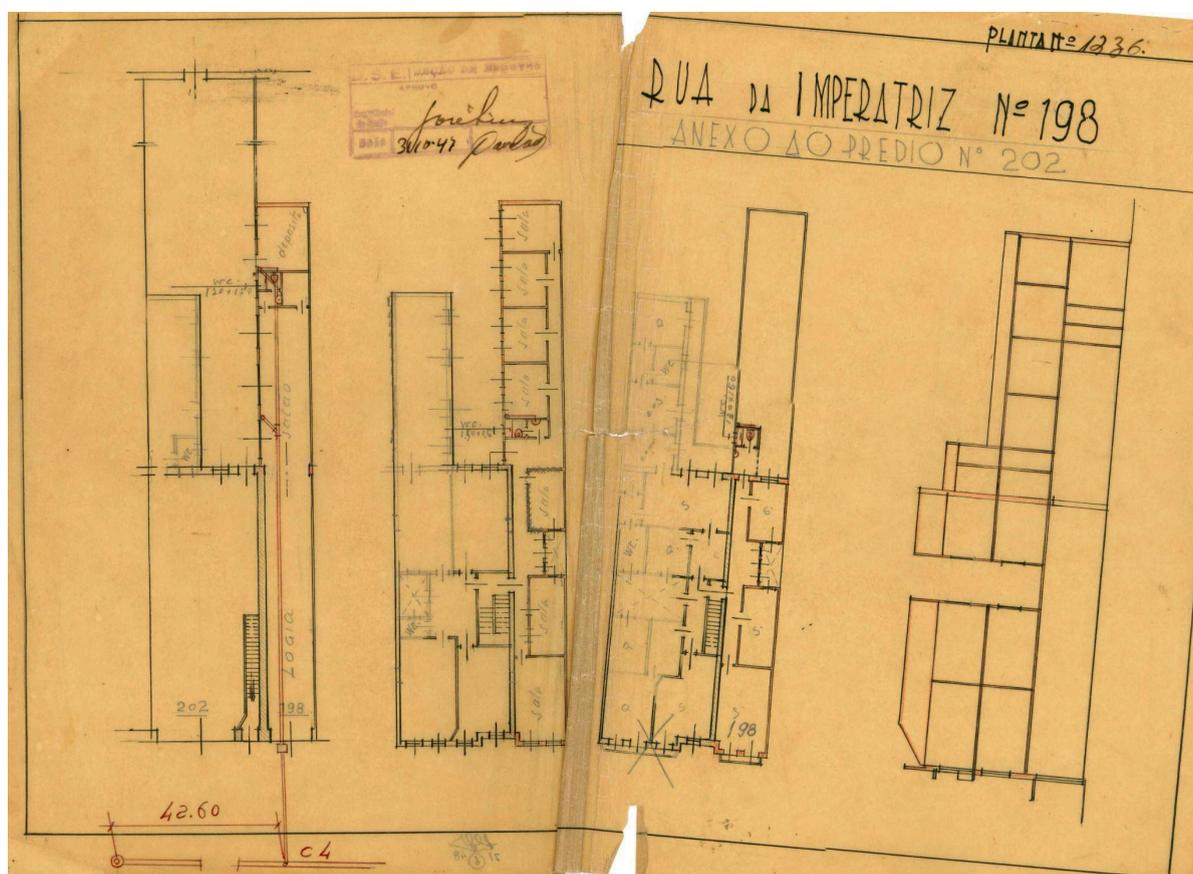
Plantas baixas do número 198 da Rua da Imperatriz, anexo ao Edifício Coelho, nº 202. O banheiro representado no segundo pavimento, posicionado onde na verdade foi construído um terraço, provavelmente nunca chegou a existir. Os dos outros pavimentos sim.
